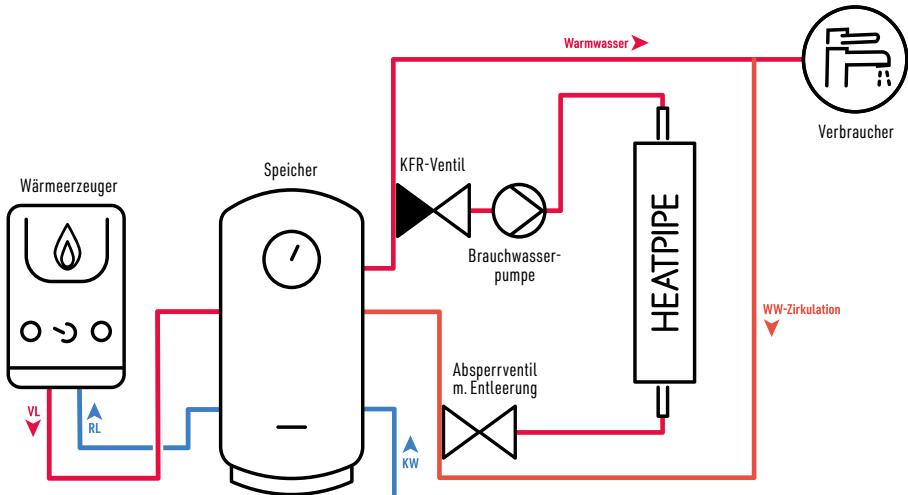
Beispiel-Schema | Einbau via Bypass innerhalb der Warmwasser-Zirkulationleitung
